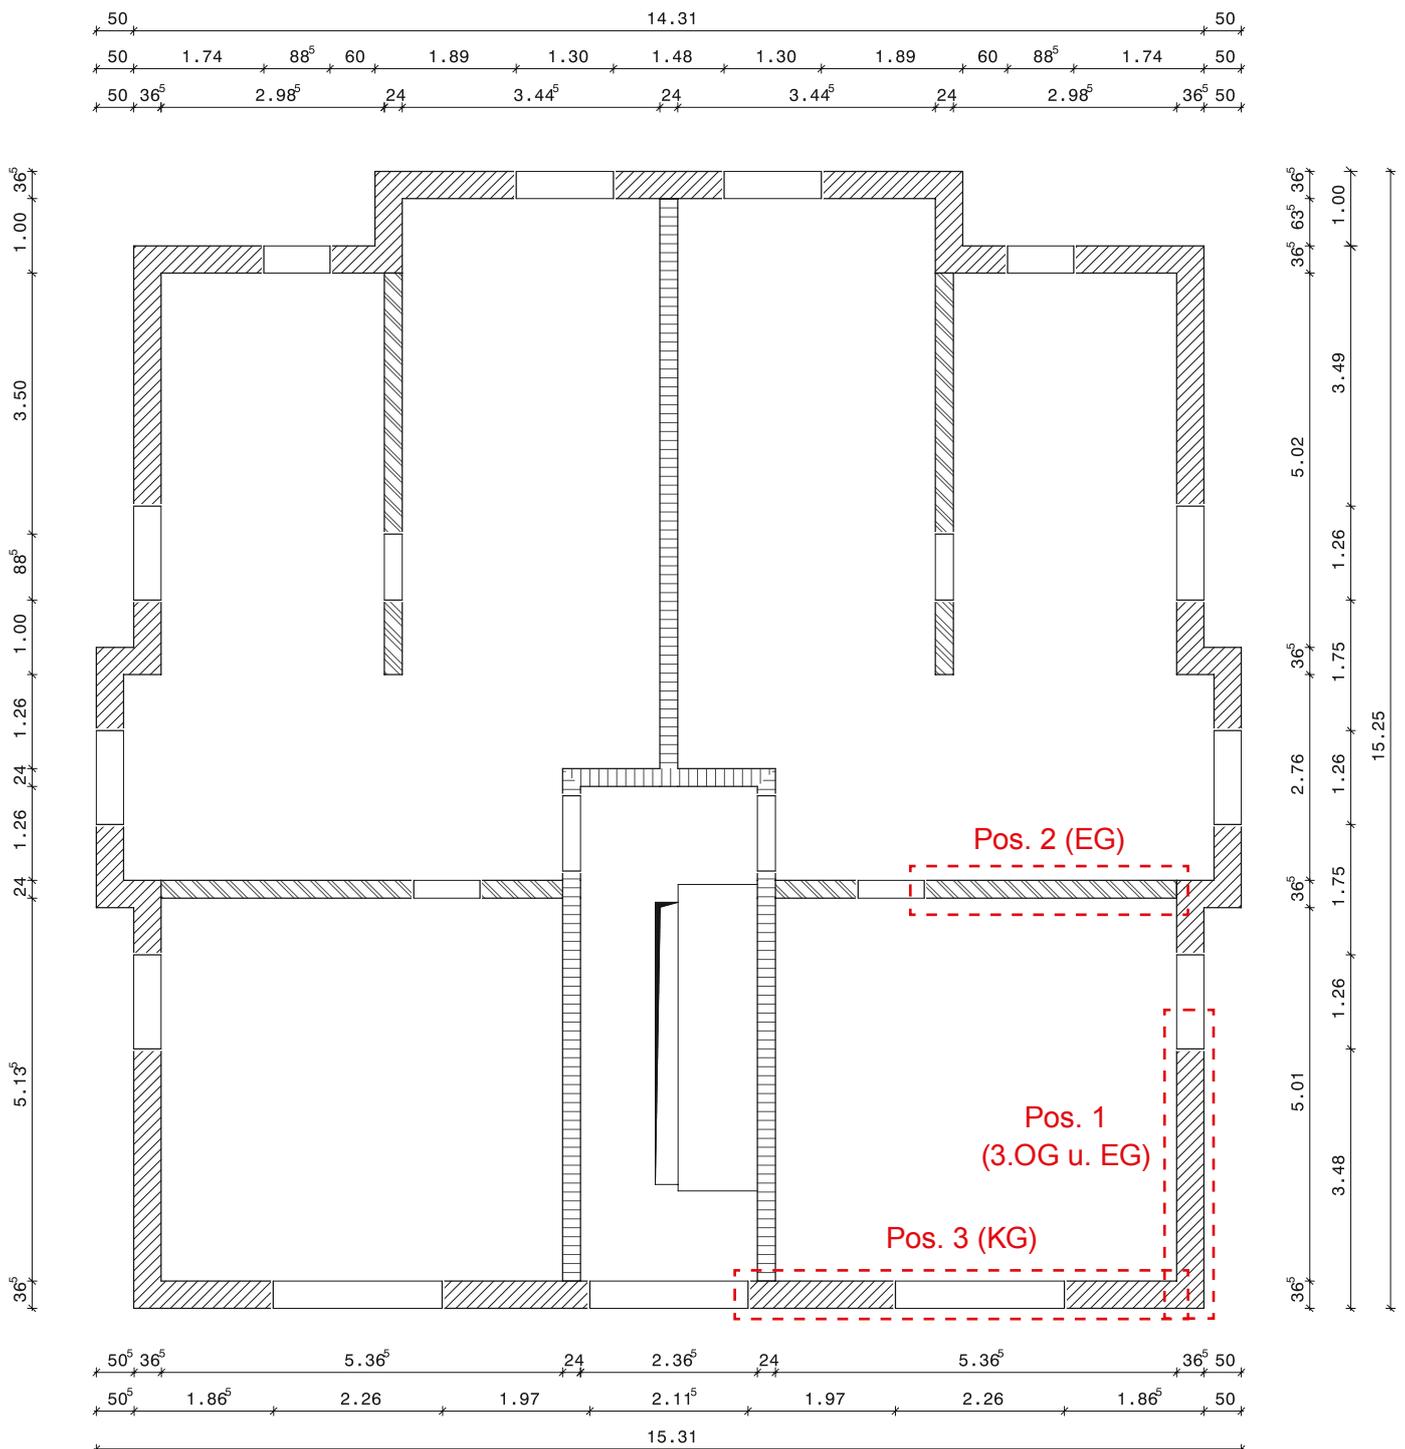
Grundriss der Geschosse EG bis 3. OG
